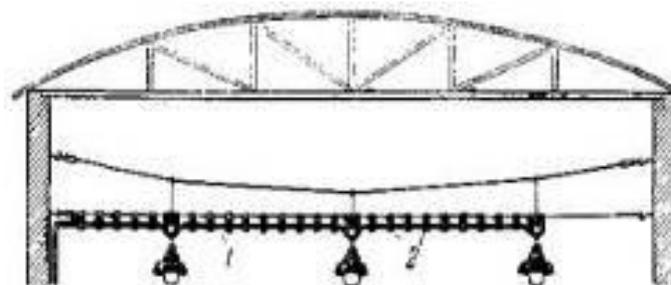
Прокладка кабеля на тросе: 1-кабель; 2-подвески У954-У961
